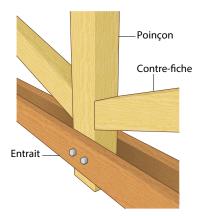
Exemple d'assemblage entrait moisé – poinçon par 2 boulons
